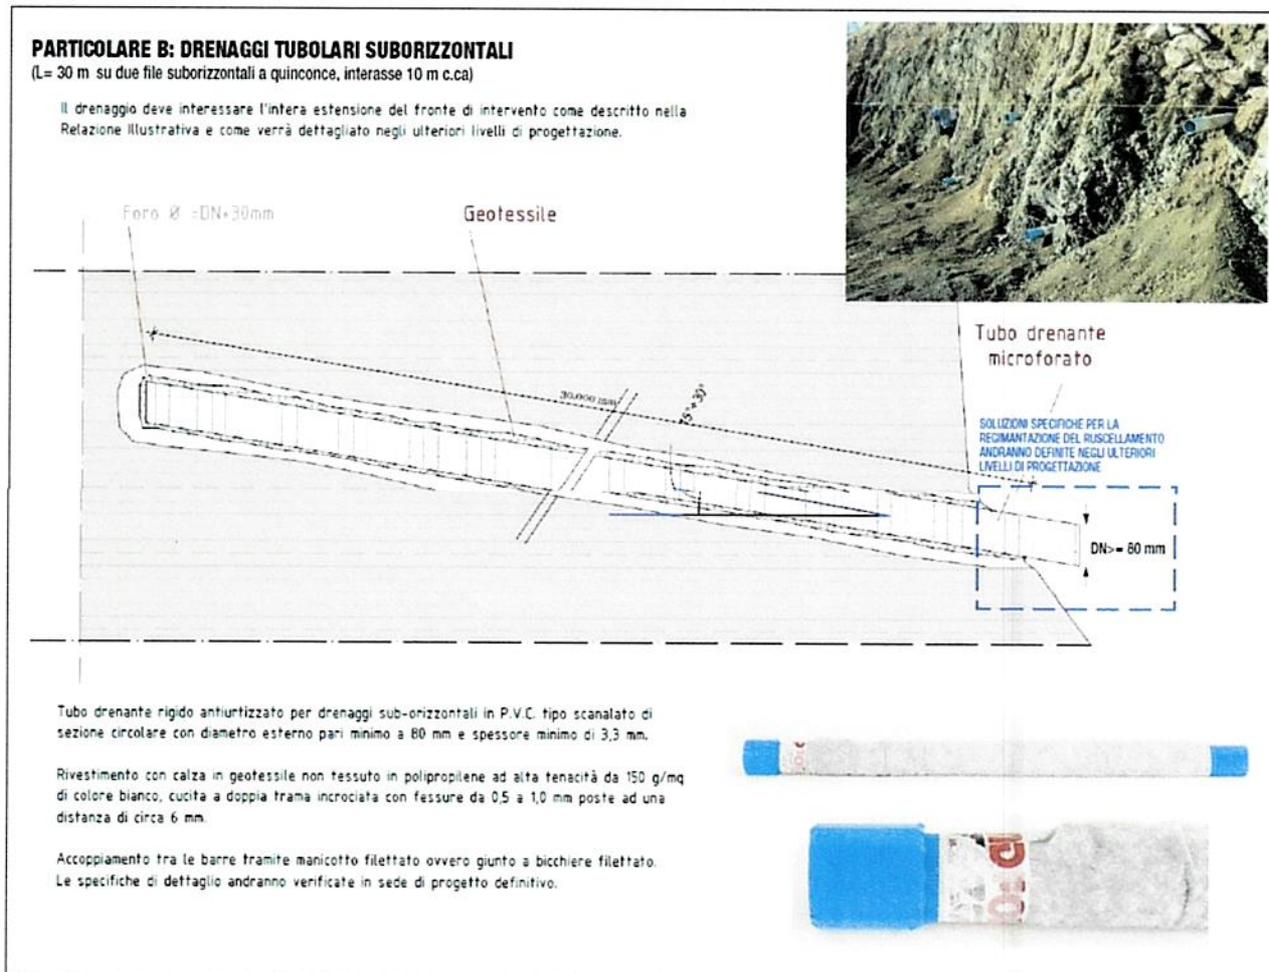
Particolare drenaggi tubolari suborizzontali (elab. OP.04)
